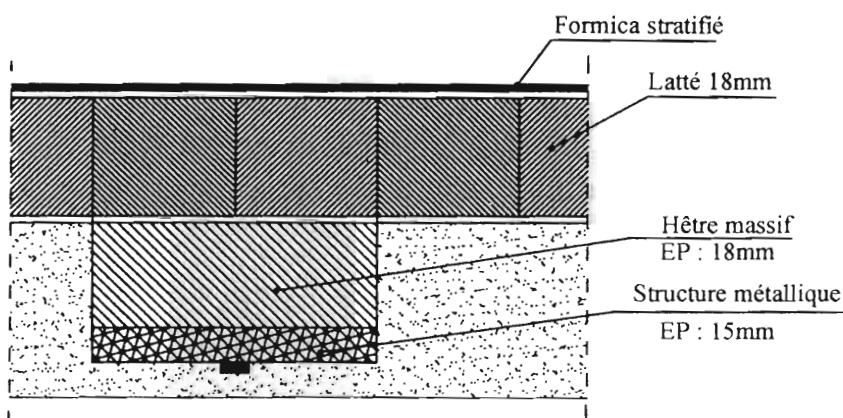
DETAIL DE LA PLANCHE DE TRAVAIL OU TOP
